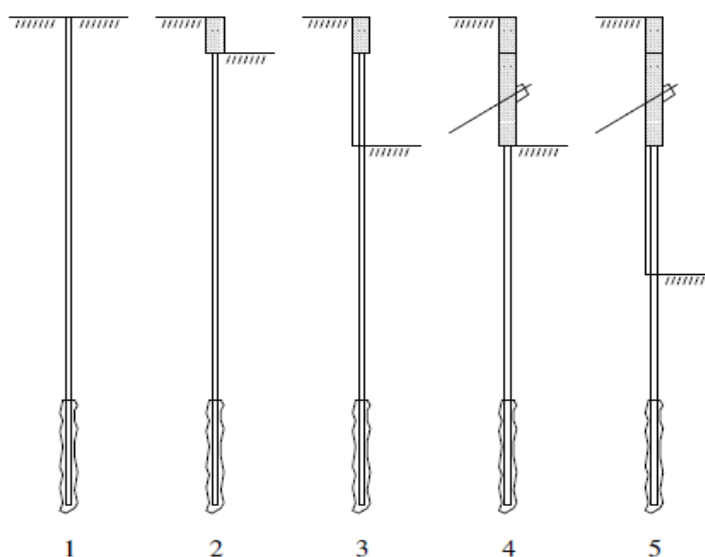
Fases de construção de uma parede do tipo Berlim definitivas (Guerra, 2009)
